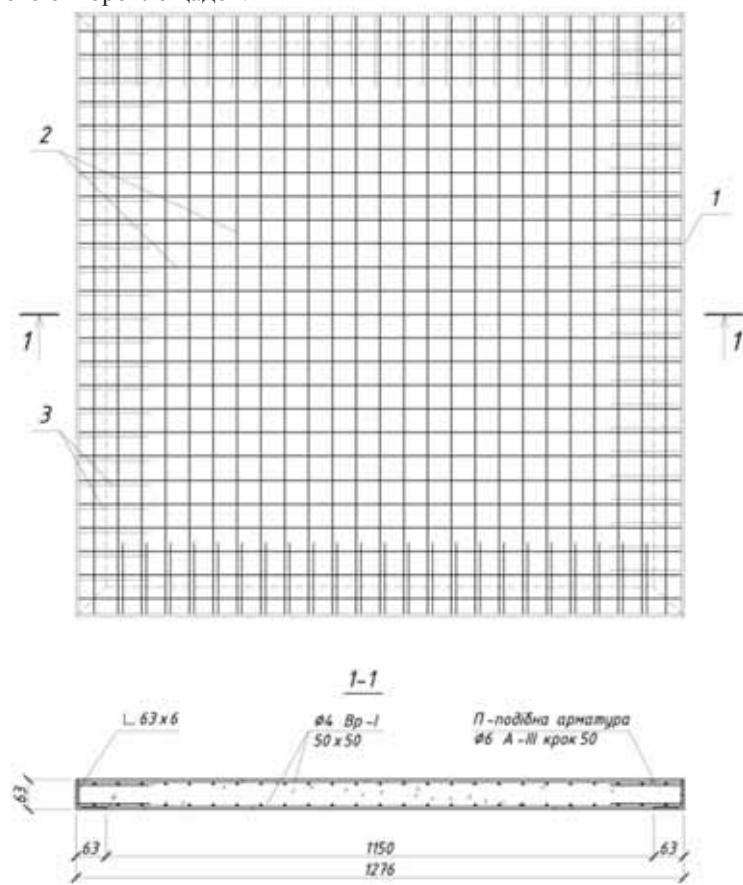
Дослідні зразки панелей перекриття ПВ 63-1:
